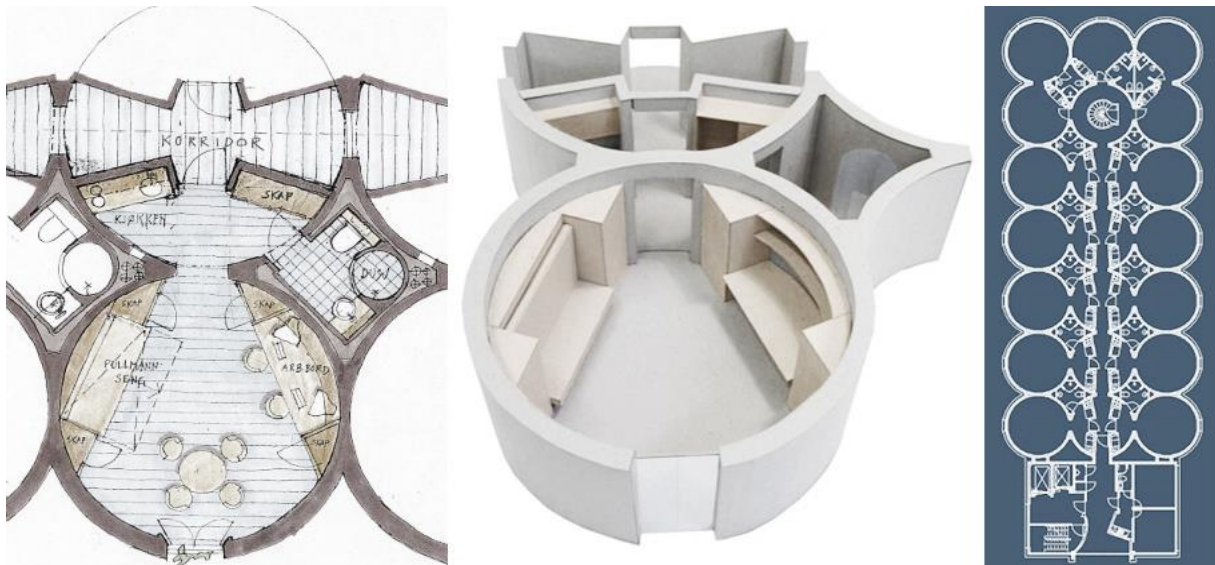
Grundriss einer Wohnzelle, Abb.22: Model einer Wohnzelle, Abb.23. Grundriss eines Regelgeschosses
